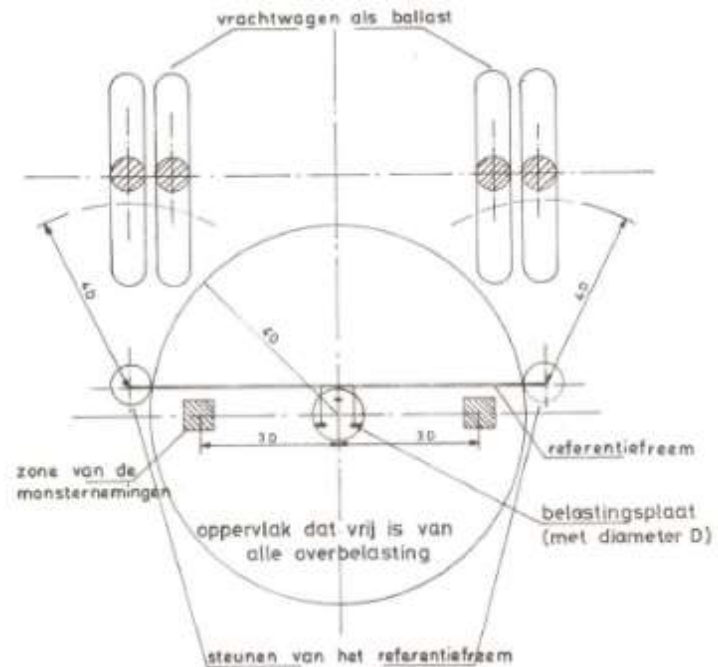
Lieu de l'essai de portance à la plaque, vue en plan
